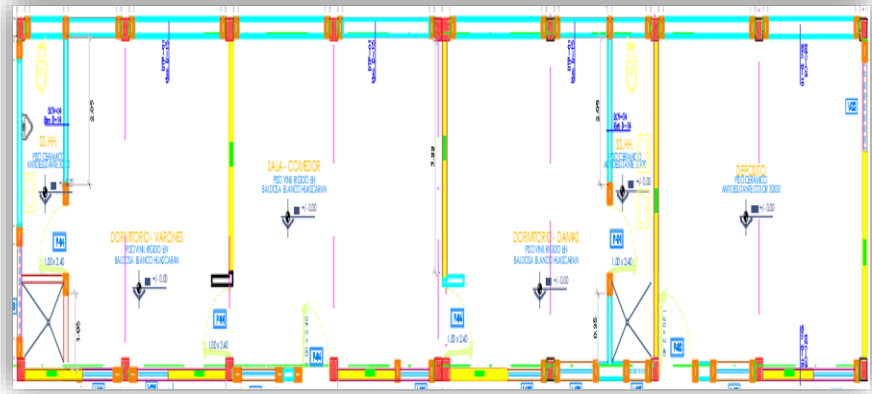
Plano de arquitectura de los bloques 7 y 8, Administrativo y Vivienda, primer piso
